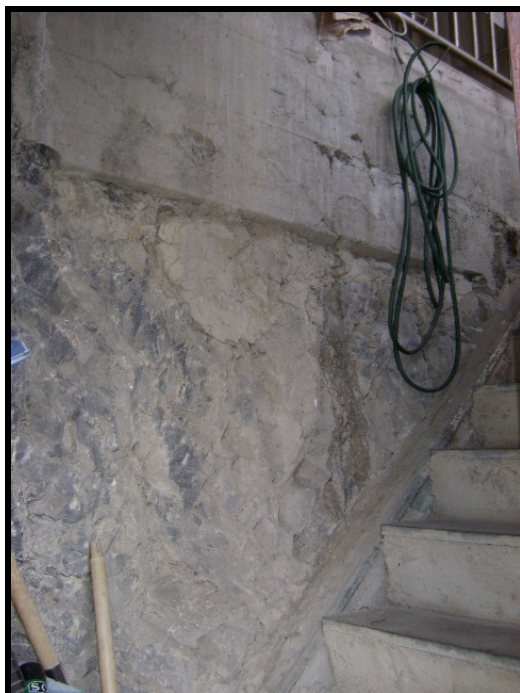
Se muestra como las casas adyacentes a la carretera utilizan el mármol de fondo en sus paredes.
